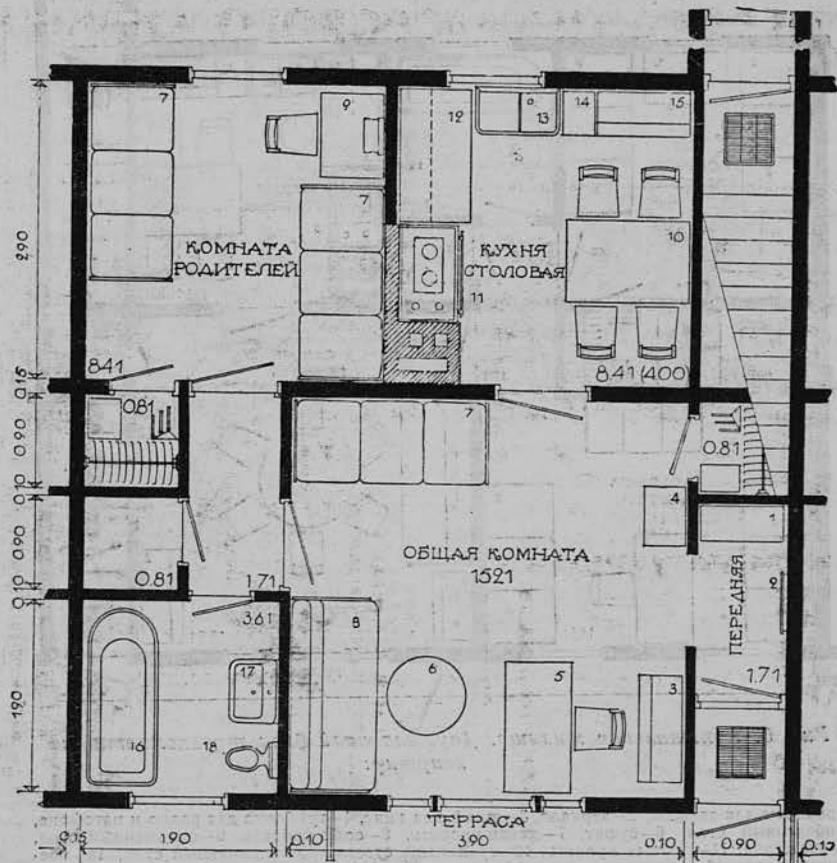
Капитальное жилище. Двухэтажный блок двухкомнатных квартир:
